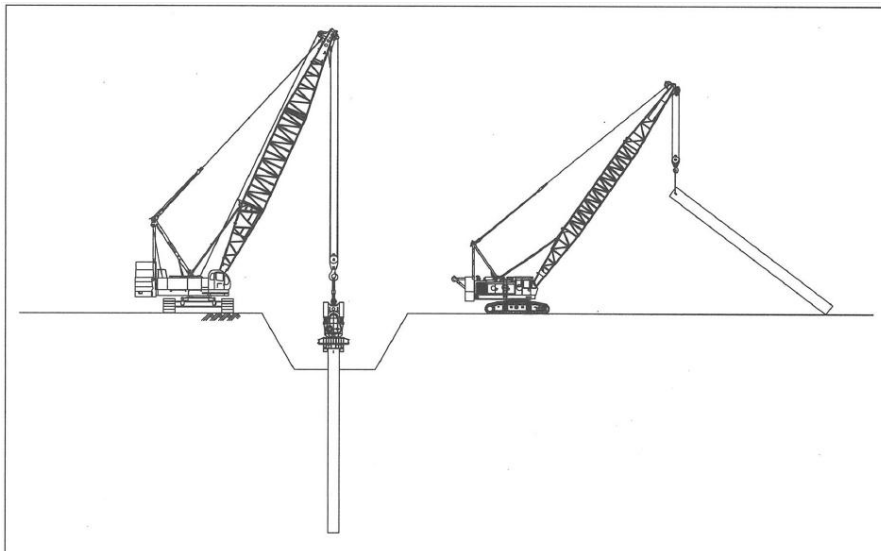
床掘りして施工する場合の施工手順例 (出典 5.10-②)
